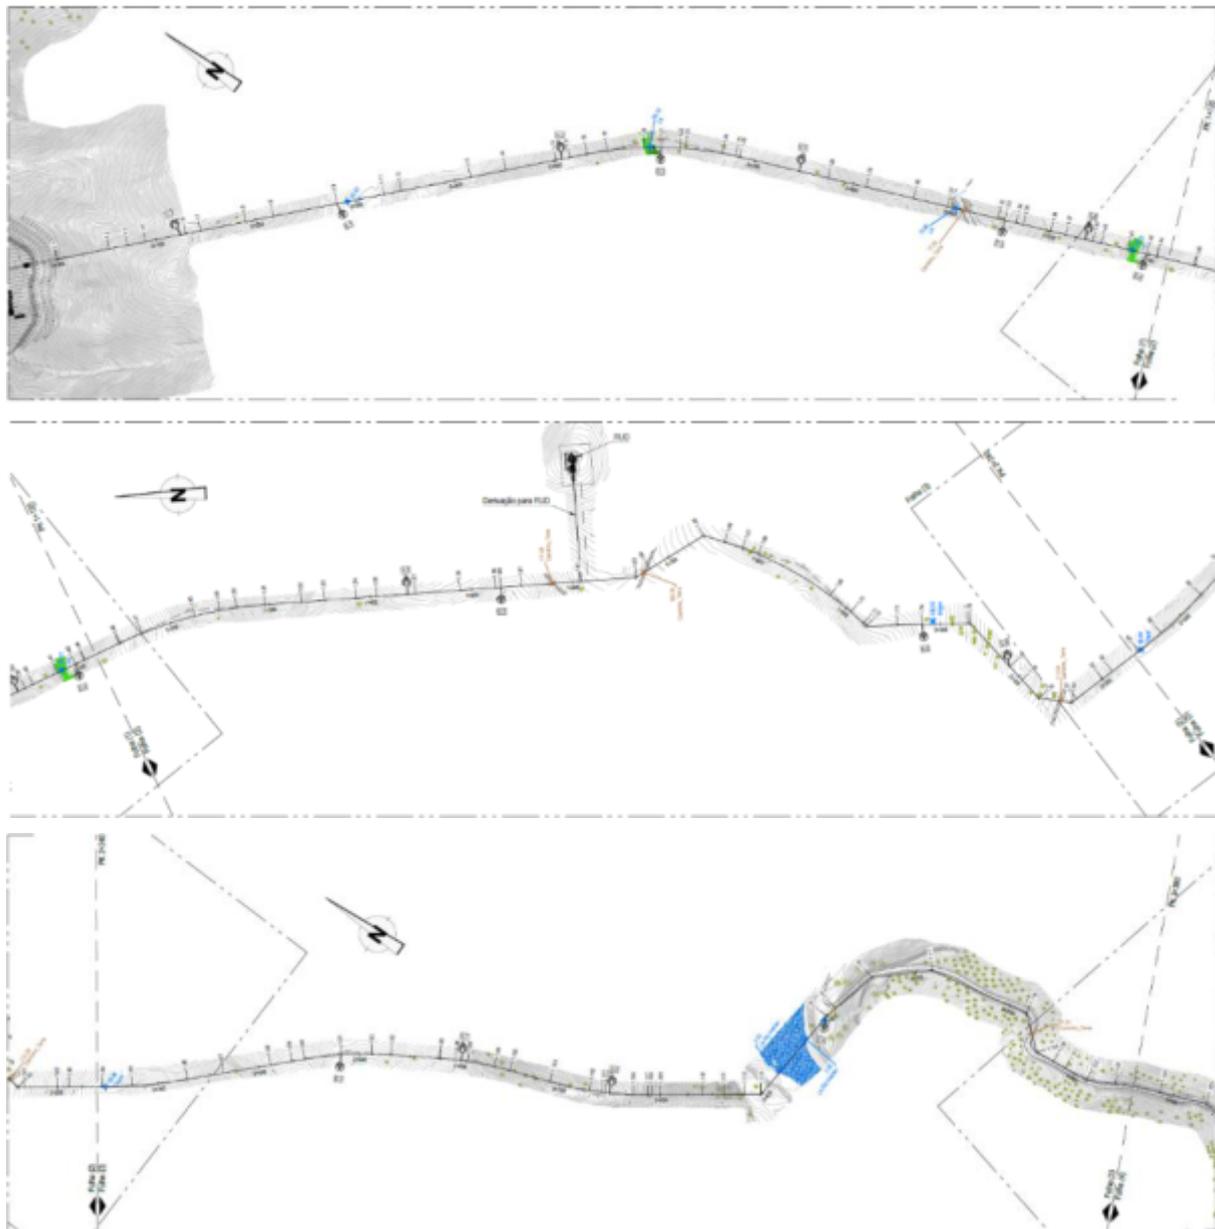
Excerto do Desenho 04 (PR-22355-HD) - Planta e Perfil Longitudinal da Conduto Elevatória (3 folhas)
